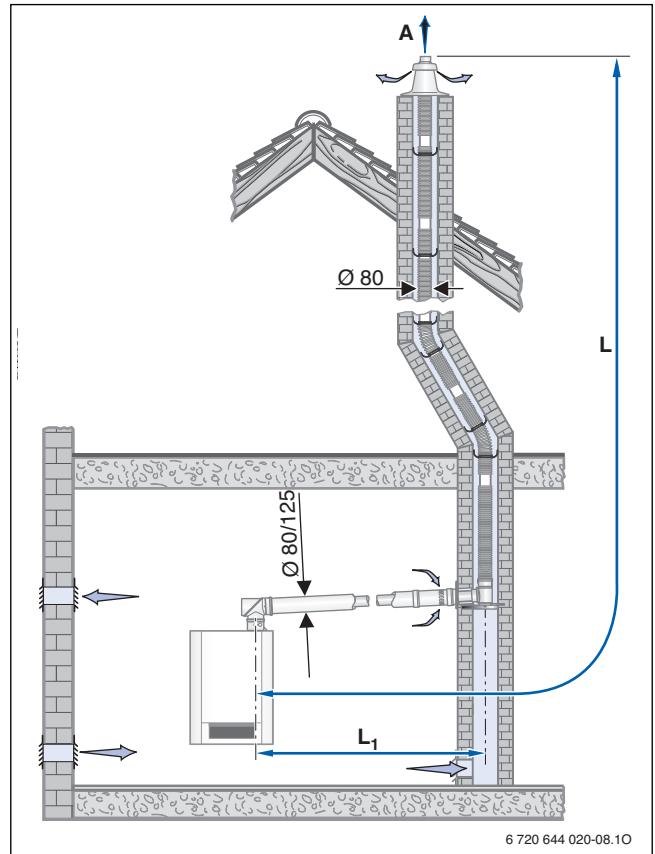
Montagevariante mit dem Bausatz GA-X + GA-K + ÜB-Flex
